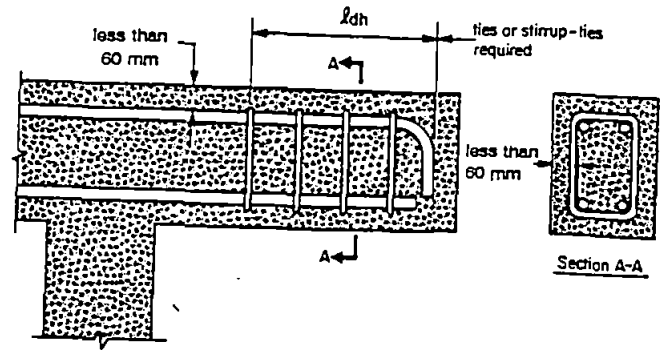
Recubrimiento del hormigón según la sección 12.5.4.
